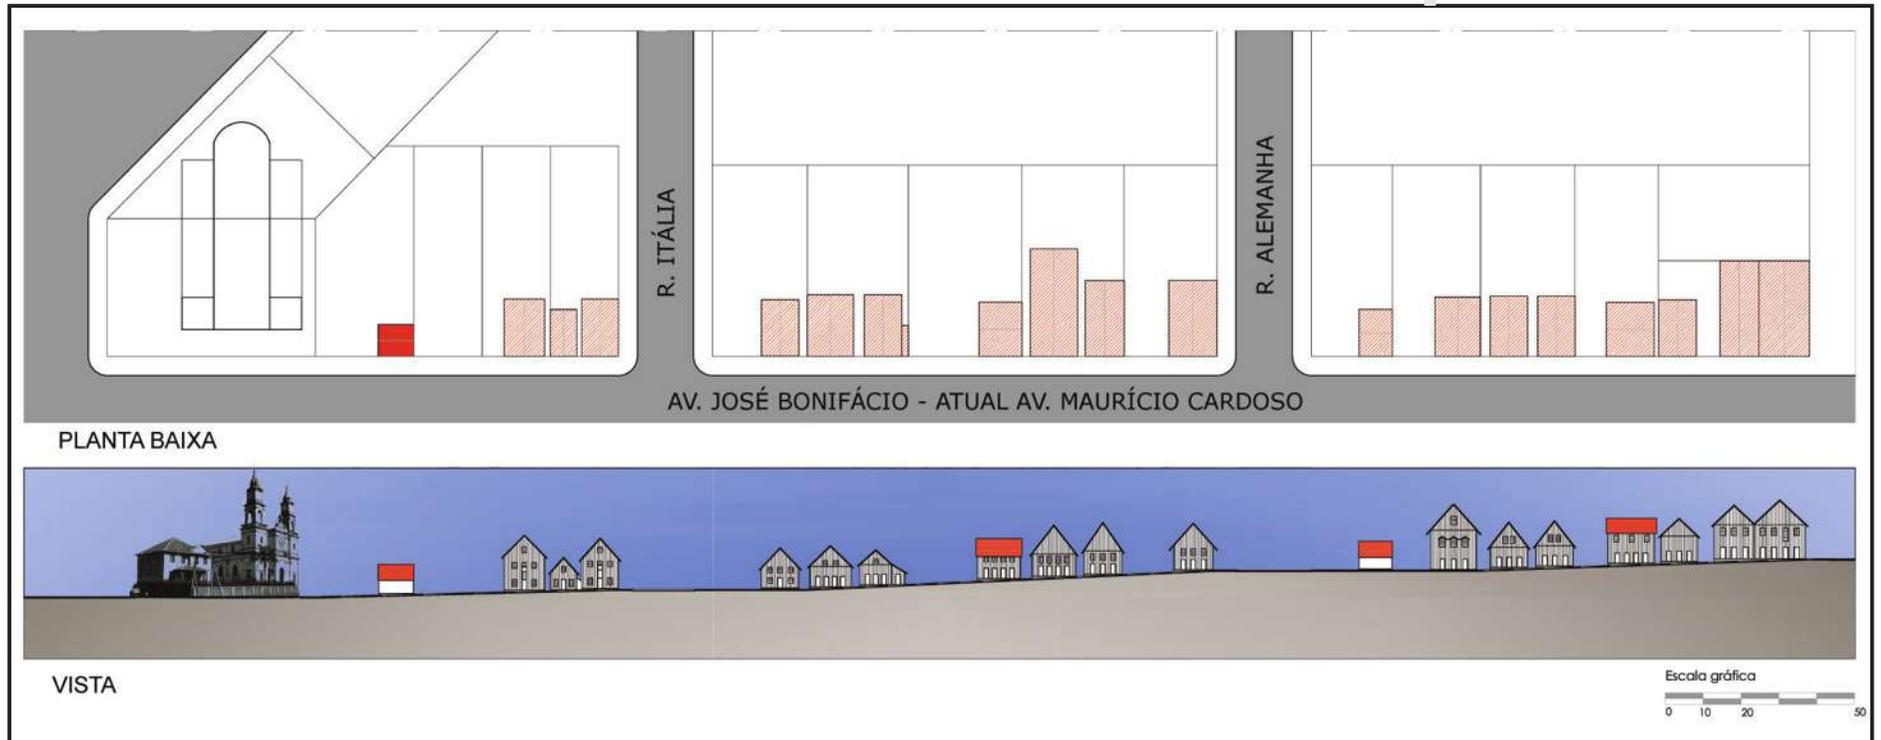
Planta baixa e vista oeste da via central elaborada a partir de fotografias da década de trinta.
